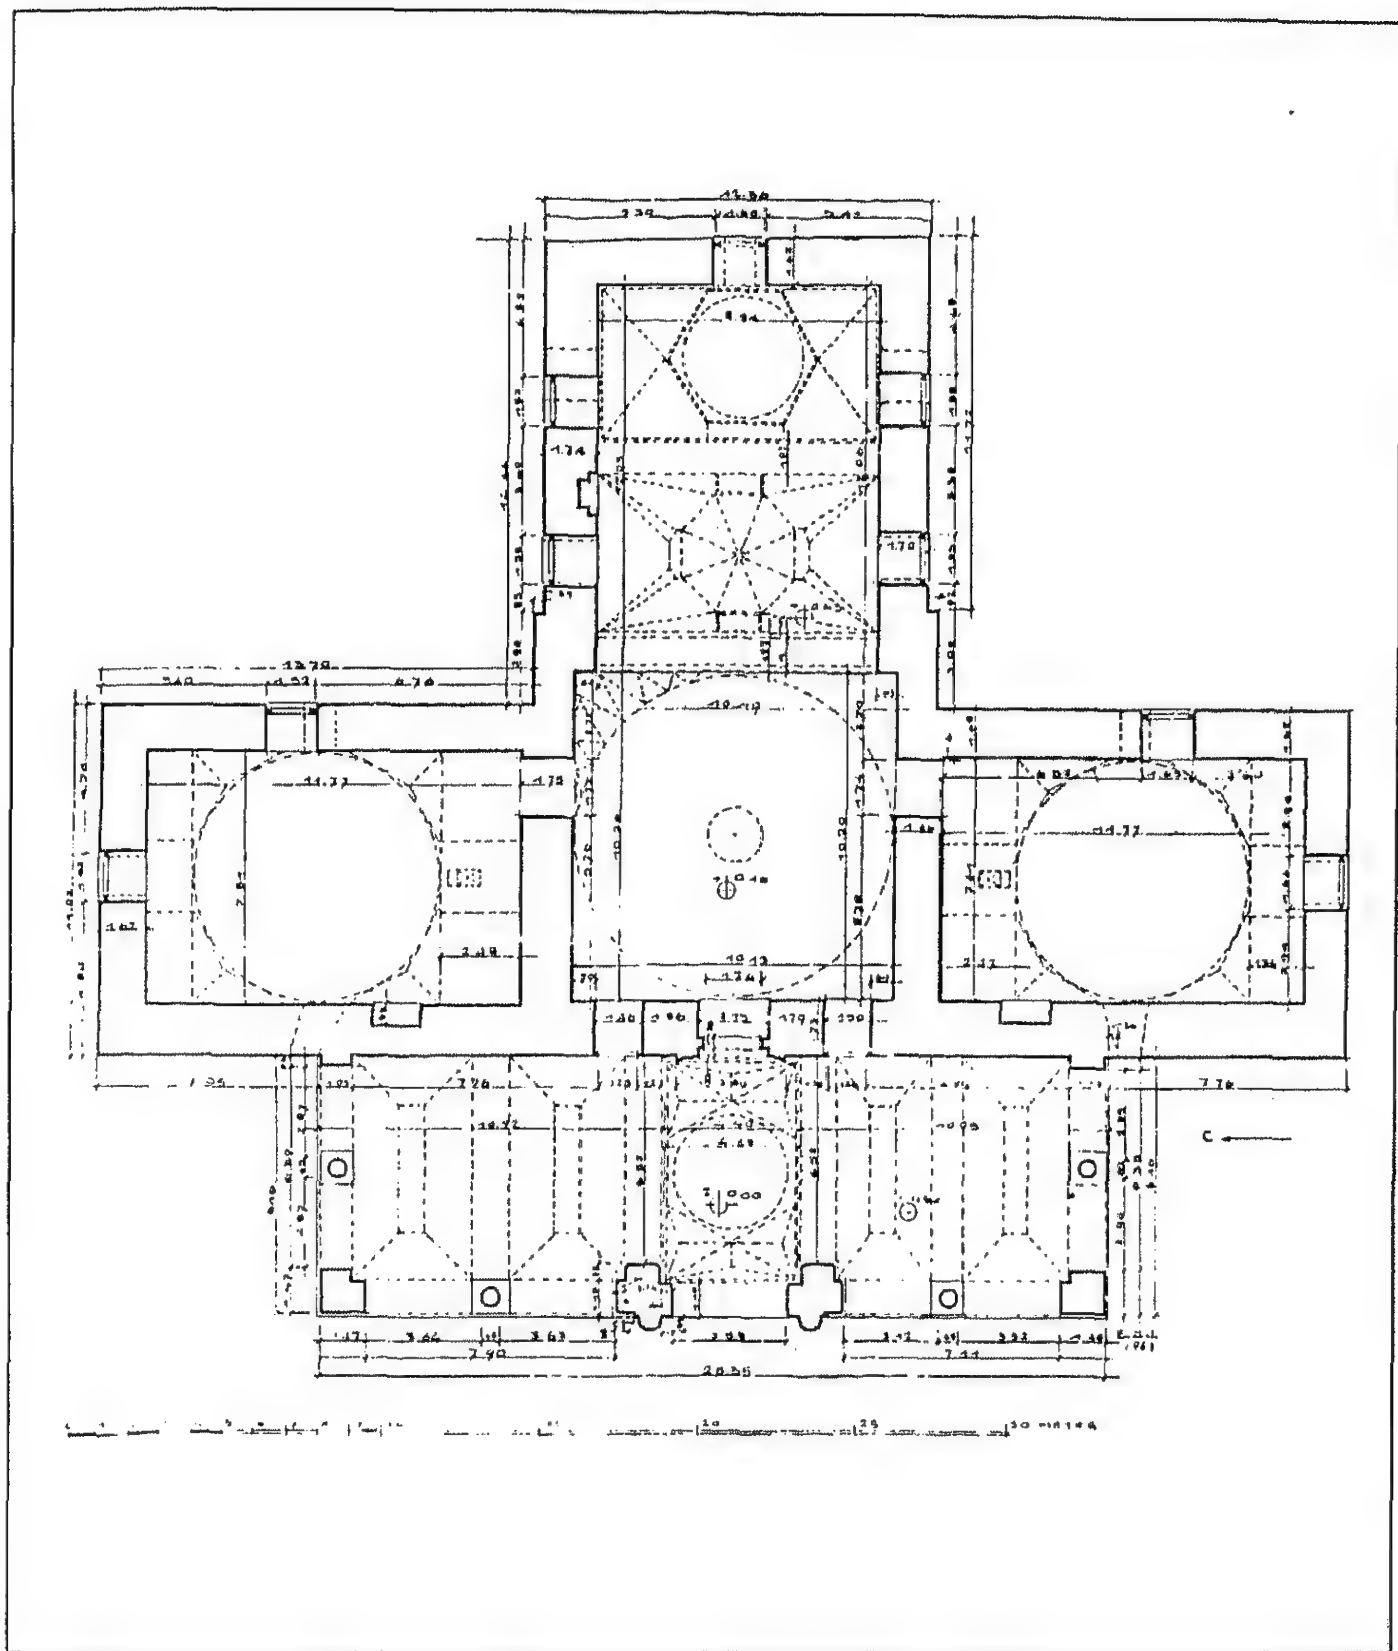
مسقط أفقي لعمارت غازي اورنوس بك في كوموتيني باليونان
